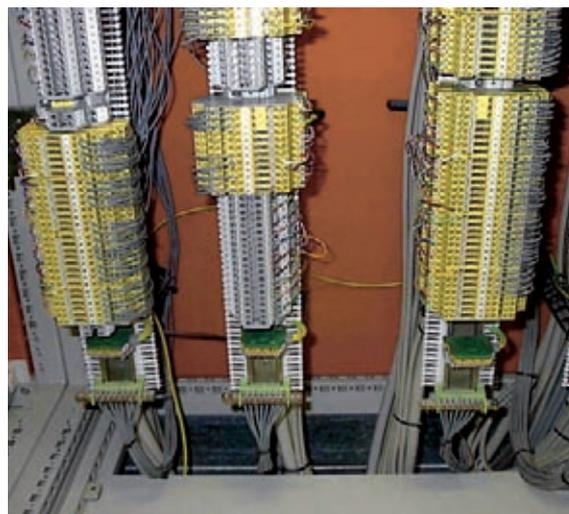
Dispositivi di protezione da sovratensioni DEHNconnect. Entrata dei cavi dall'intercapedine nel pavimento
